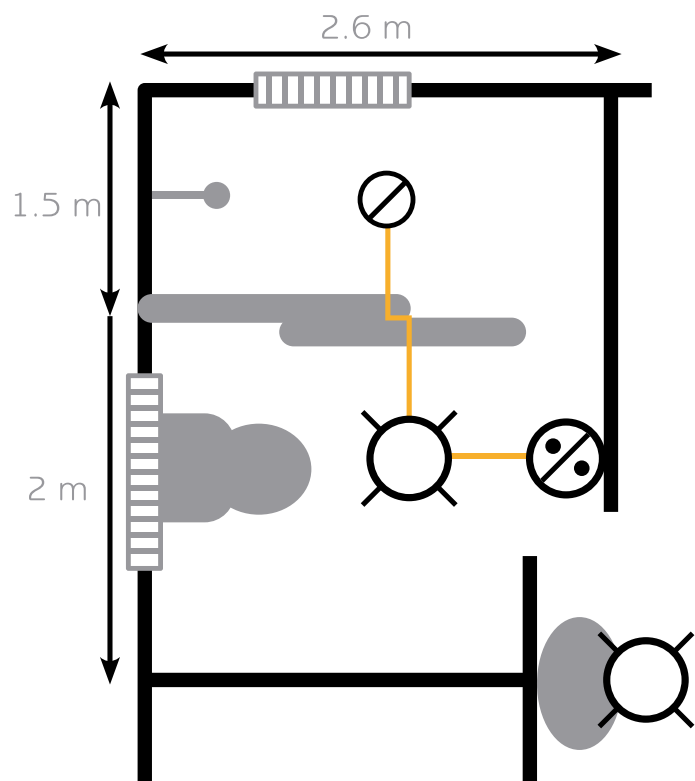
Parte del plano correspondiente al baño de una vivienda.
